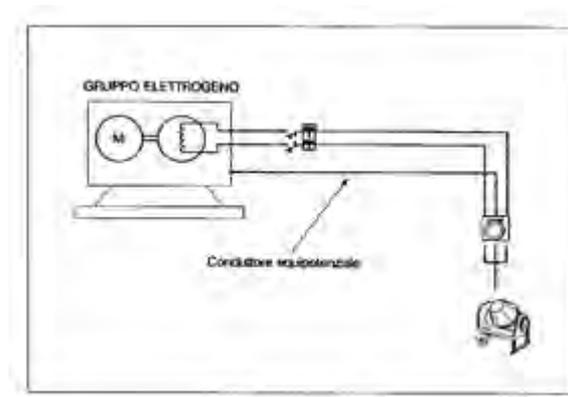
Schema dei collegamenti tra le apparecchiature ed un piccolo gruppo elettrogeno protetto per separazione elettrica. [Figura tratta dal volume "Impianti a norme CEI, cantieri edili", edizione Tuttonormel, Torino]
